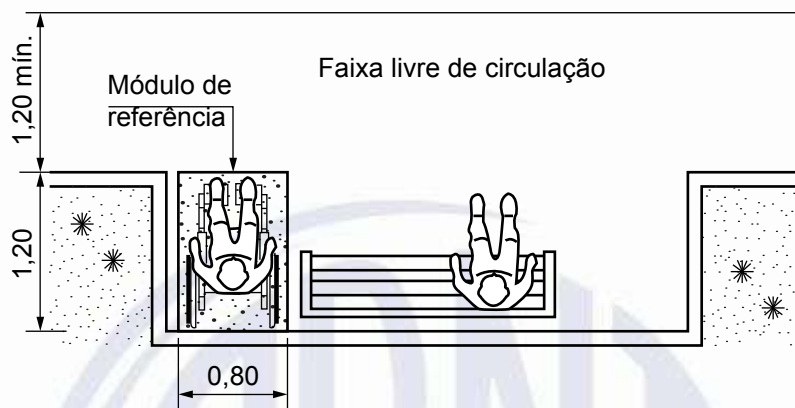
Banco – Área para transferência – Exemplo – Vista superior
